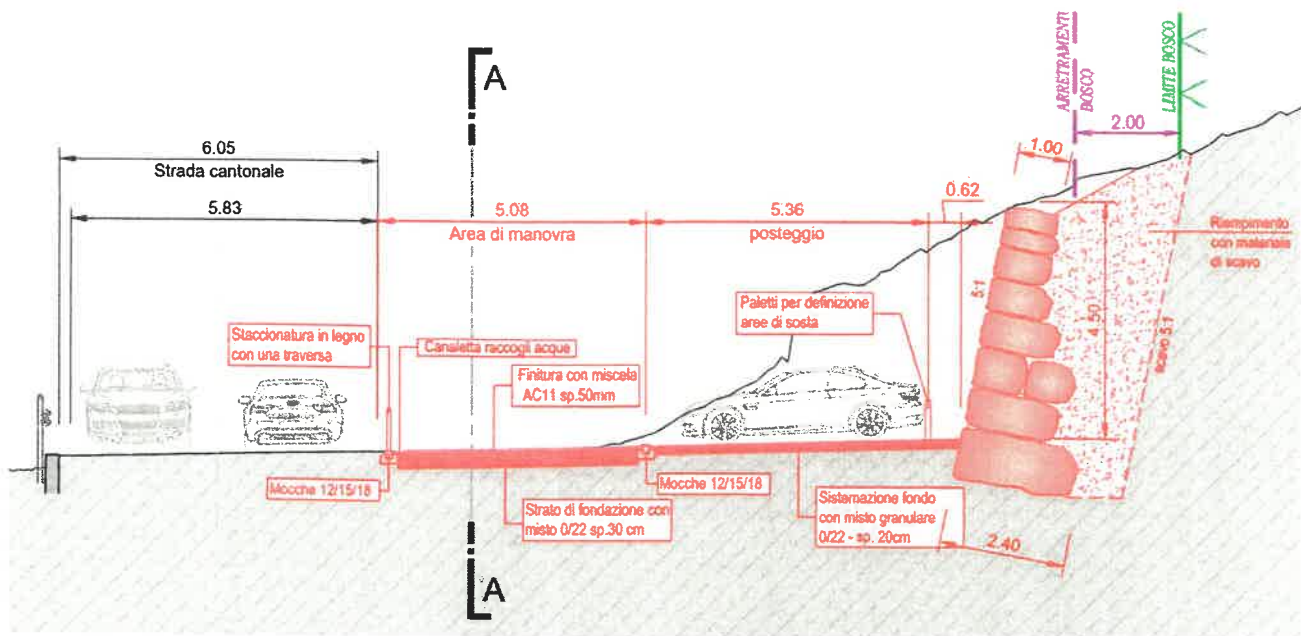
Sezione C-C - area di sosta e muro di contenimento
